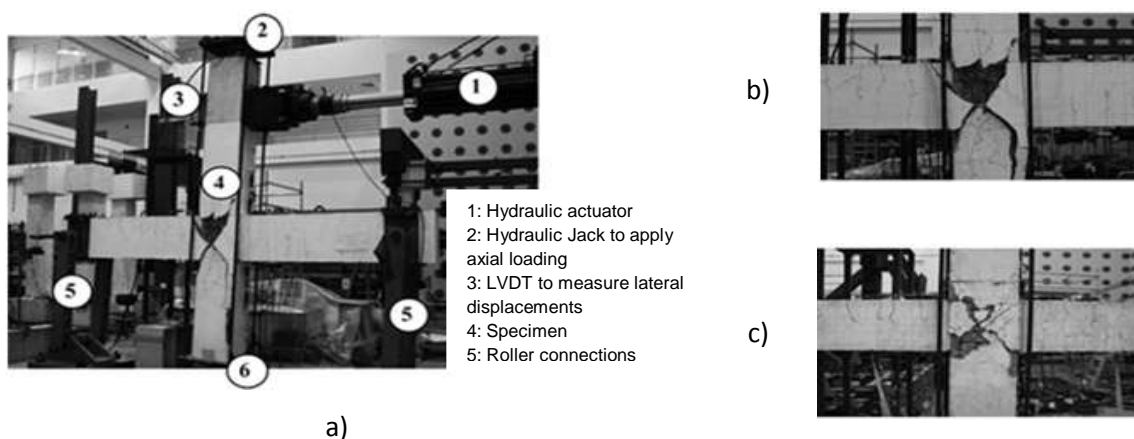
Plataforma de ensaio vertical [25]: a) configuração geral da estrutura; b) dano no provete JA; c) dano no provete JC.
